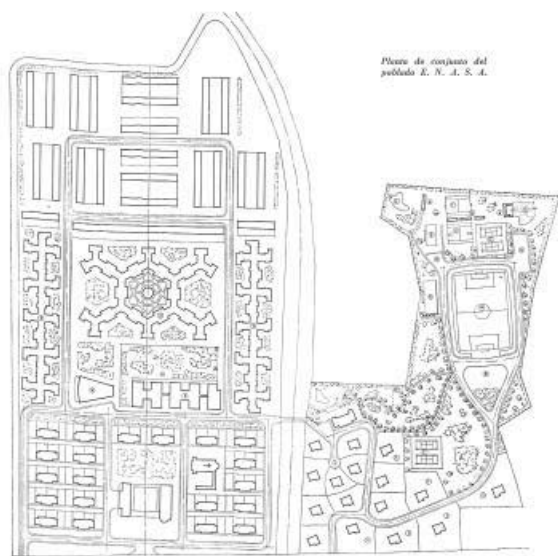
Plano de conjunto (solución descartada) Fuente: Revista Gran Madrid.
